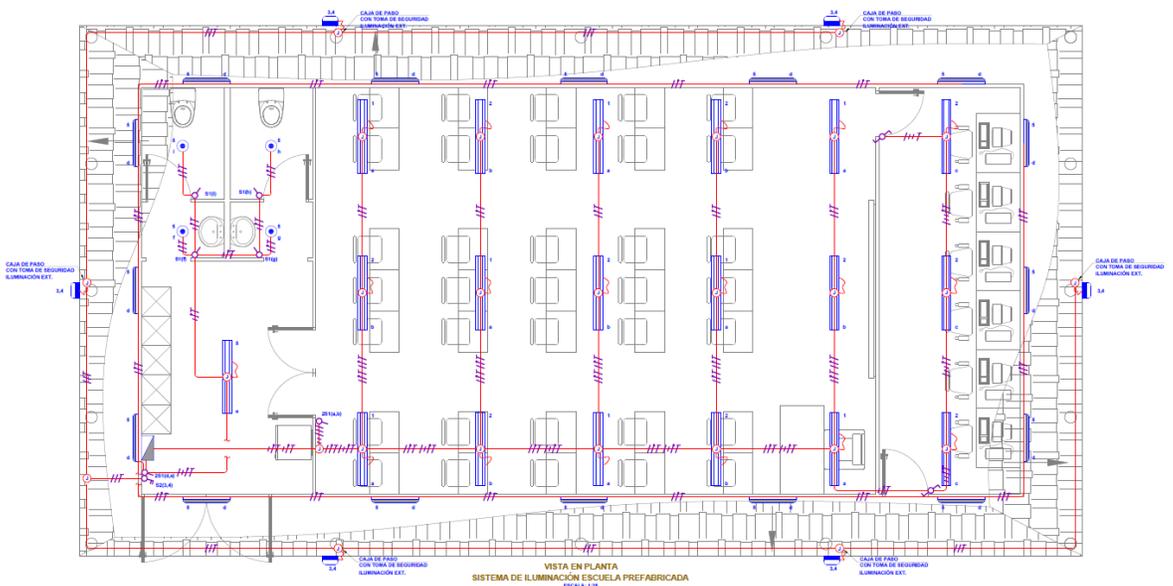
Vista en planta sistema de iluminación escuela prefabricada (los autores)
